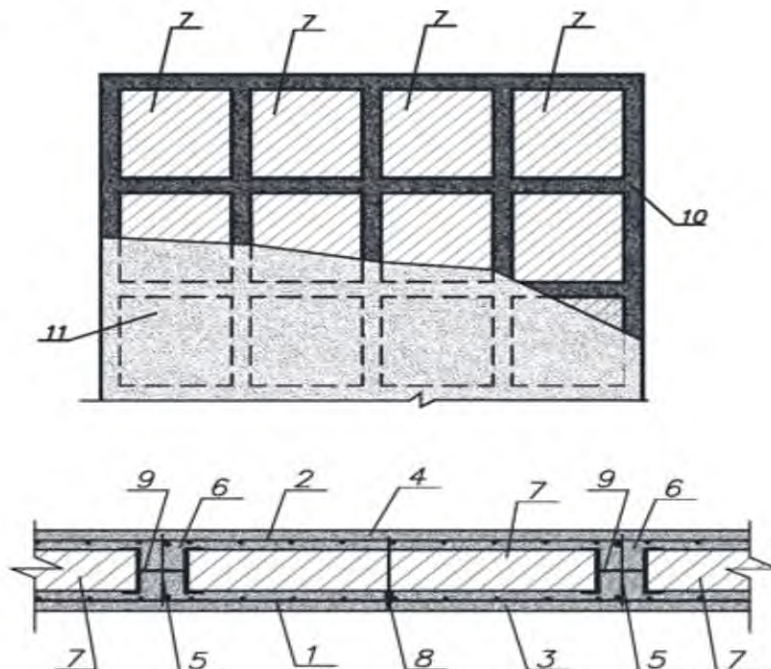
Спосіб влаштування полегшеного залізобетонного перекриття:
